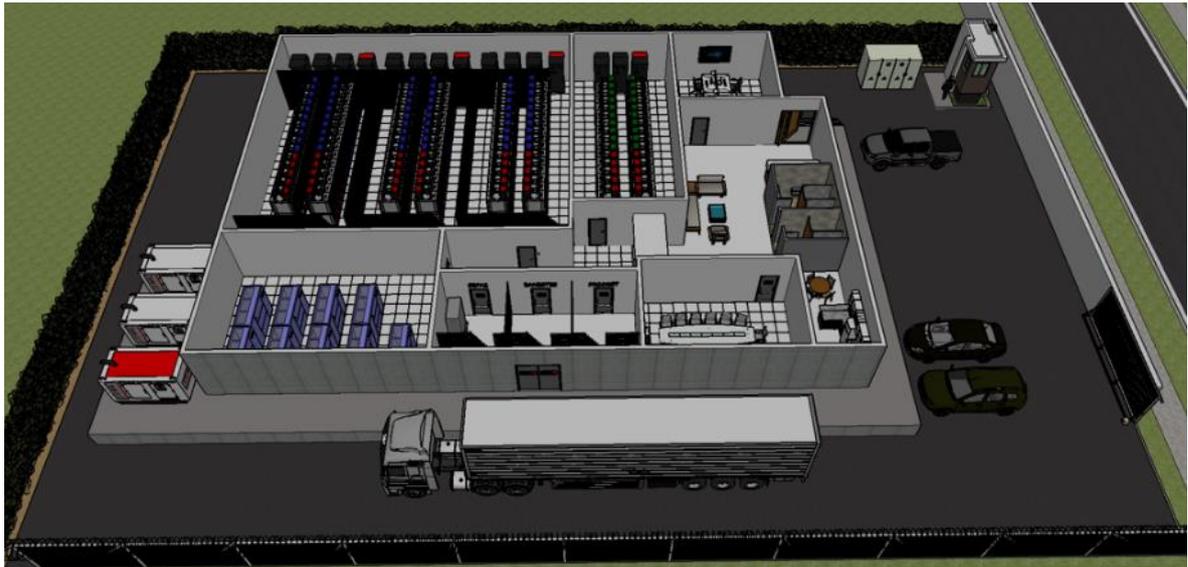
Terreno da Cesan em Santa Luzia, Serra - ES
